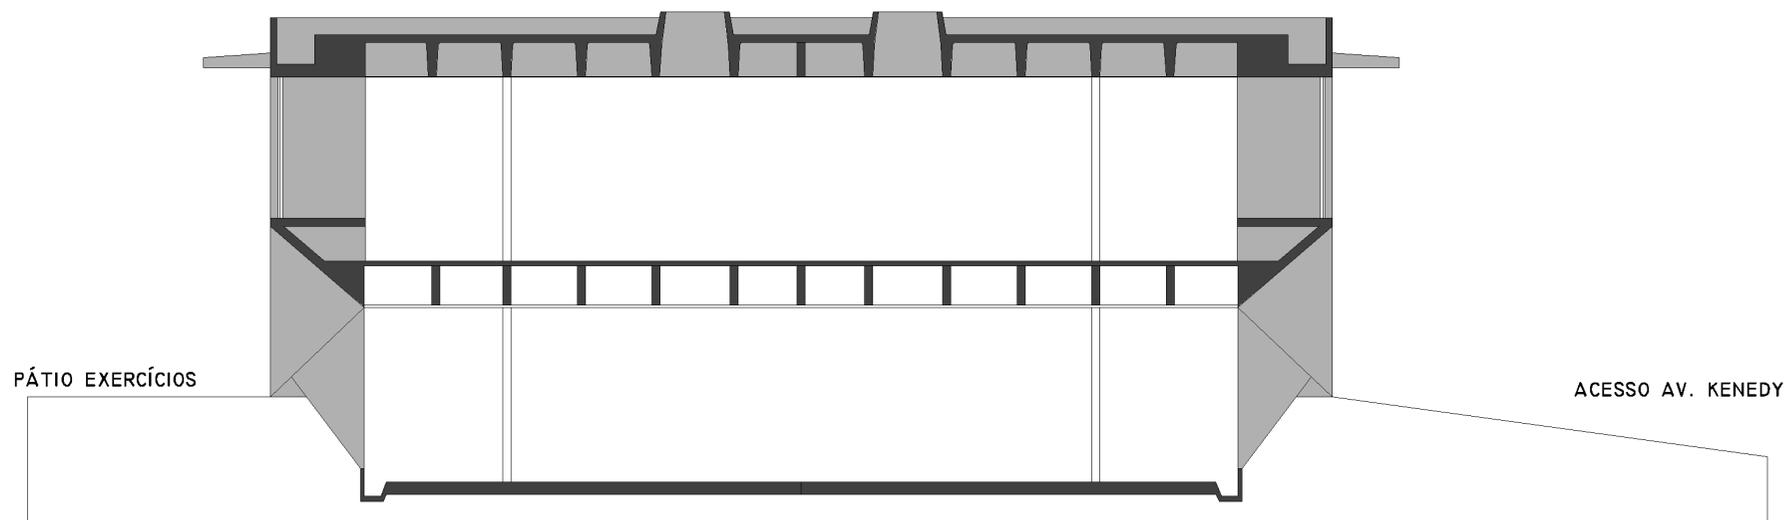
Planta e corte Edif. Bombeiros
